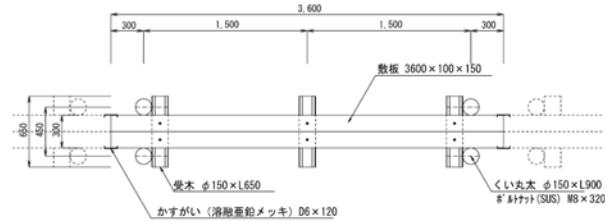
H24 調査用木道工基本設計平面図（泥炭採掘跡地側）
